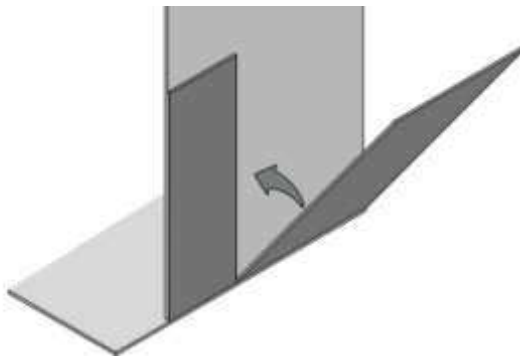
Sistema di impermeabilizzazione delle cerniere
